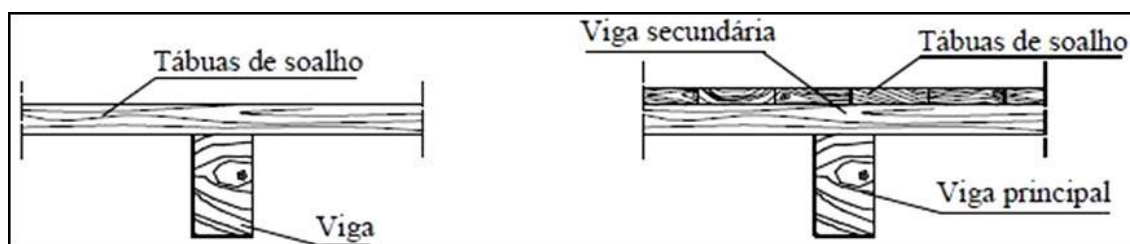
Sistema estrutural com uma viga principal e com viga secundária (Branco e Cruz, 2002)
